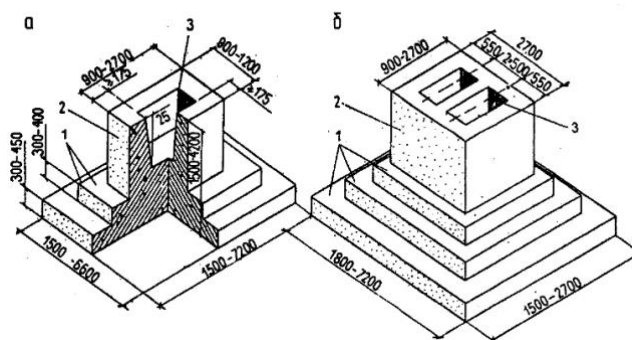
Фундамент збірних залізобетонних колон
